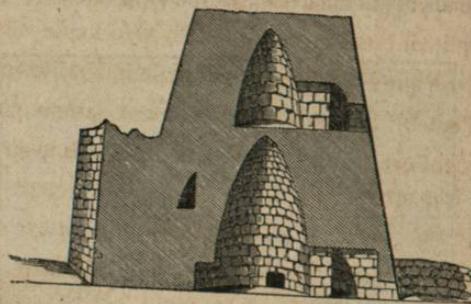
Coupe et plan du Nurhaghe de Santa-Barbara.
